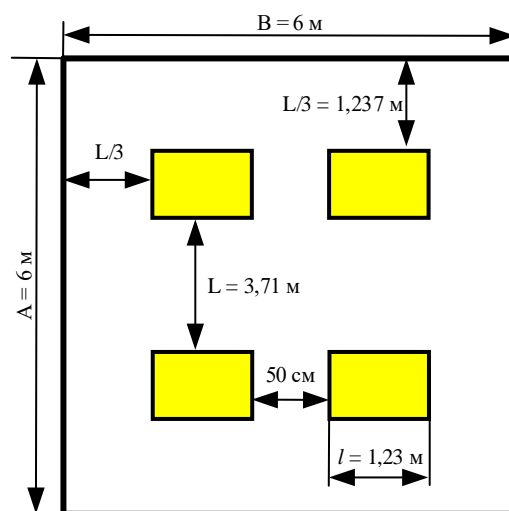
Схема размещения светильников в помещении, где $L/3$ – оптимальное расстояние от крайних светильников или рядов до стены
